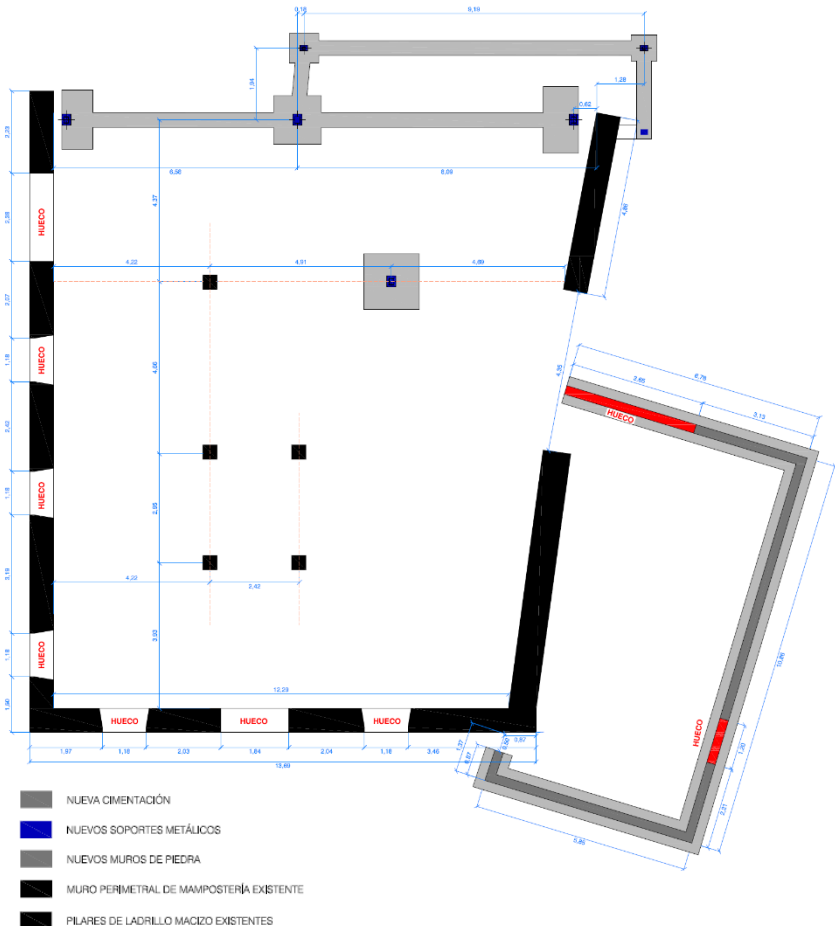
Esquema de la nueva cimentación. 2023. Fuente: propia
